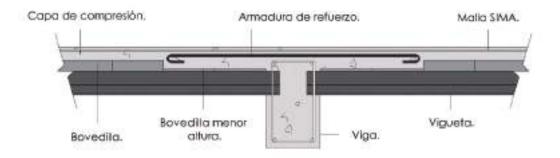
Refuerzos para viga colgante perpendicular a viguetas
